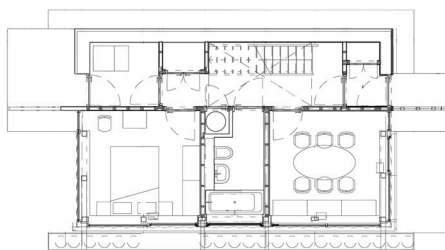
Pianta piano terra; Fonte: M. Guzowsky, 2010;
